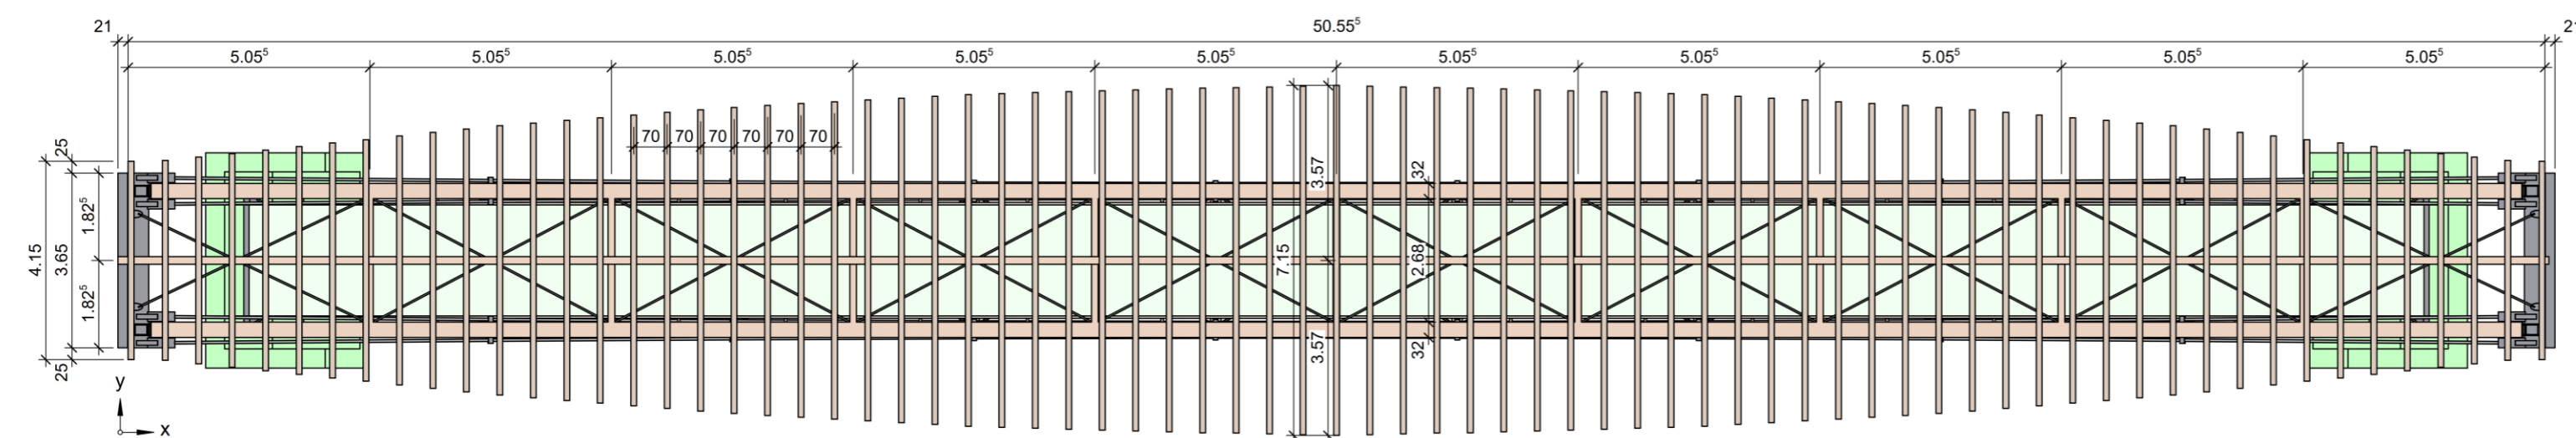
Grundriss der Fussgängerbrücke
